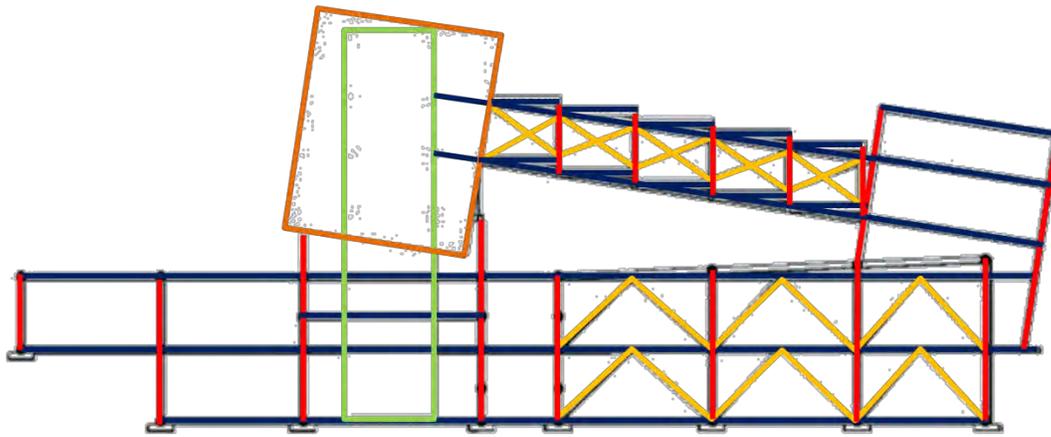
proyecto_ Esquema de modulación estructural // Fuente esta investigación
